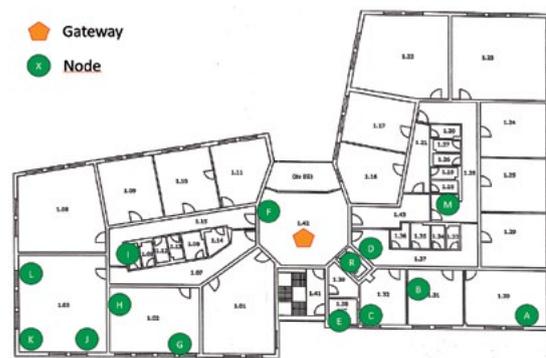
Aufbau der Reichweitenmessungen und Lageplan
